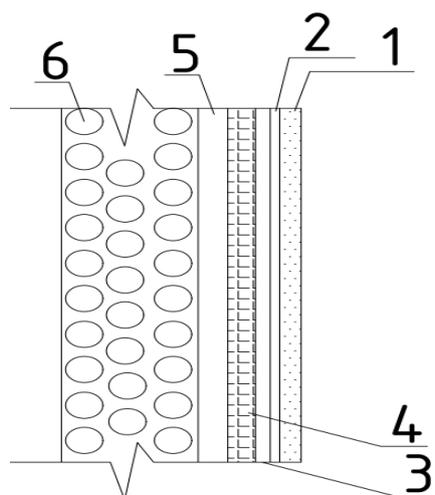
Система стены с несъемной опалубкой: 1 – искусственный или натуральный камень; 2 – клей для камня; 3 – дюбель фасадный; 4 – стеклосетка; 5 – клеевой состав; 6 – пенополистирольный блок (несъемная опалубка) [1]
